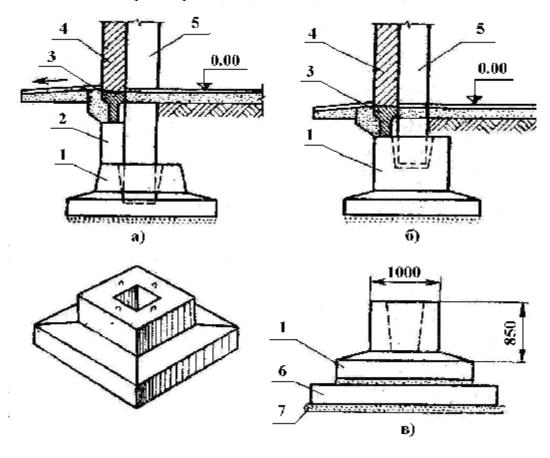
Сборные железобетонные фундаменты стаканного типа под колонны (а – стаканного типа; б – с повышенным стаканом; в – составной фундамент): 1 – фундамент (башмак); 2 – бетонный столбик; 3 – фундаментная балка; 4 – самонесущая стена; 5 – колонна; 6 – плита; 7 – бетонная подготовка
